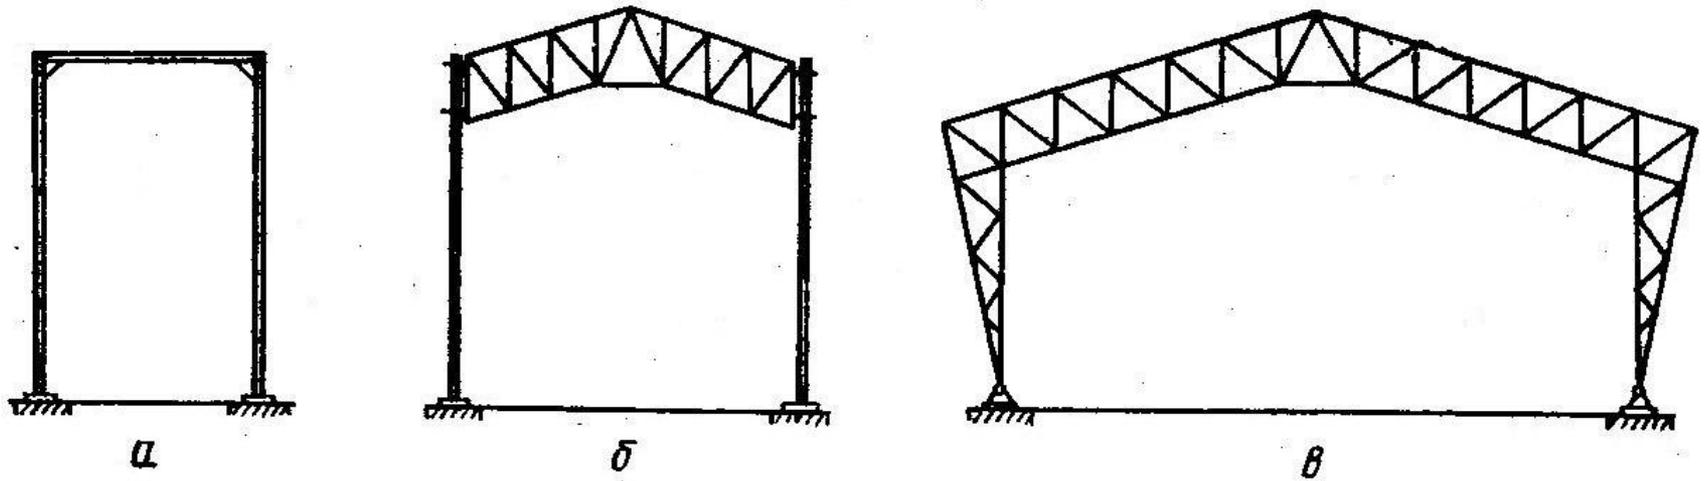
Схемы конструкций каркасов трубчатых печей:
